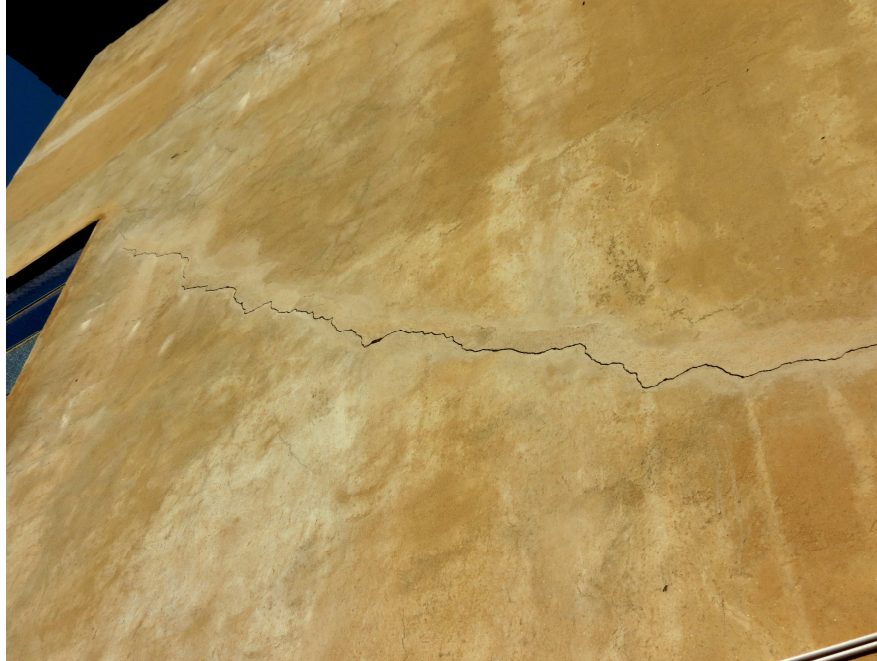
Rachaduras no quarto da área de serviço no 2º pavimento, visto da elevação lateral esquerda.
